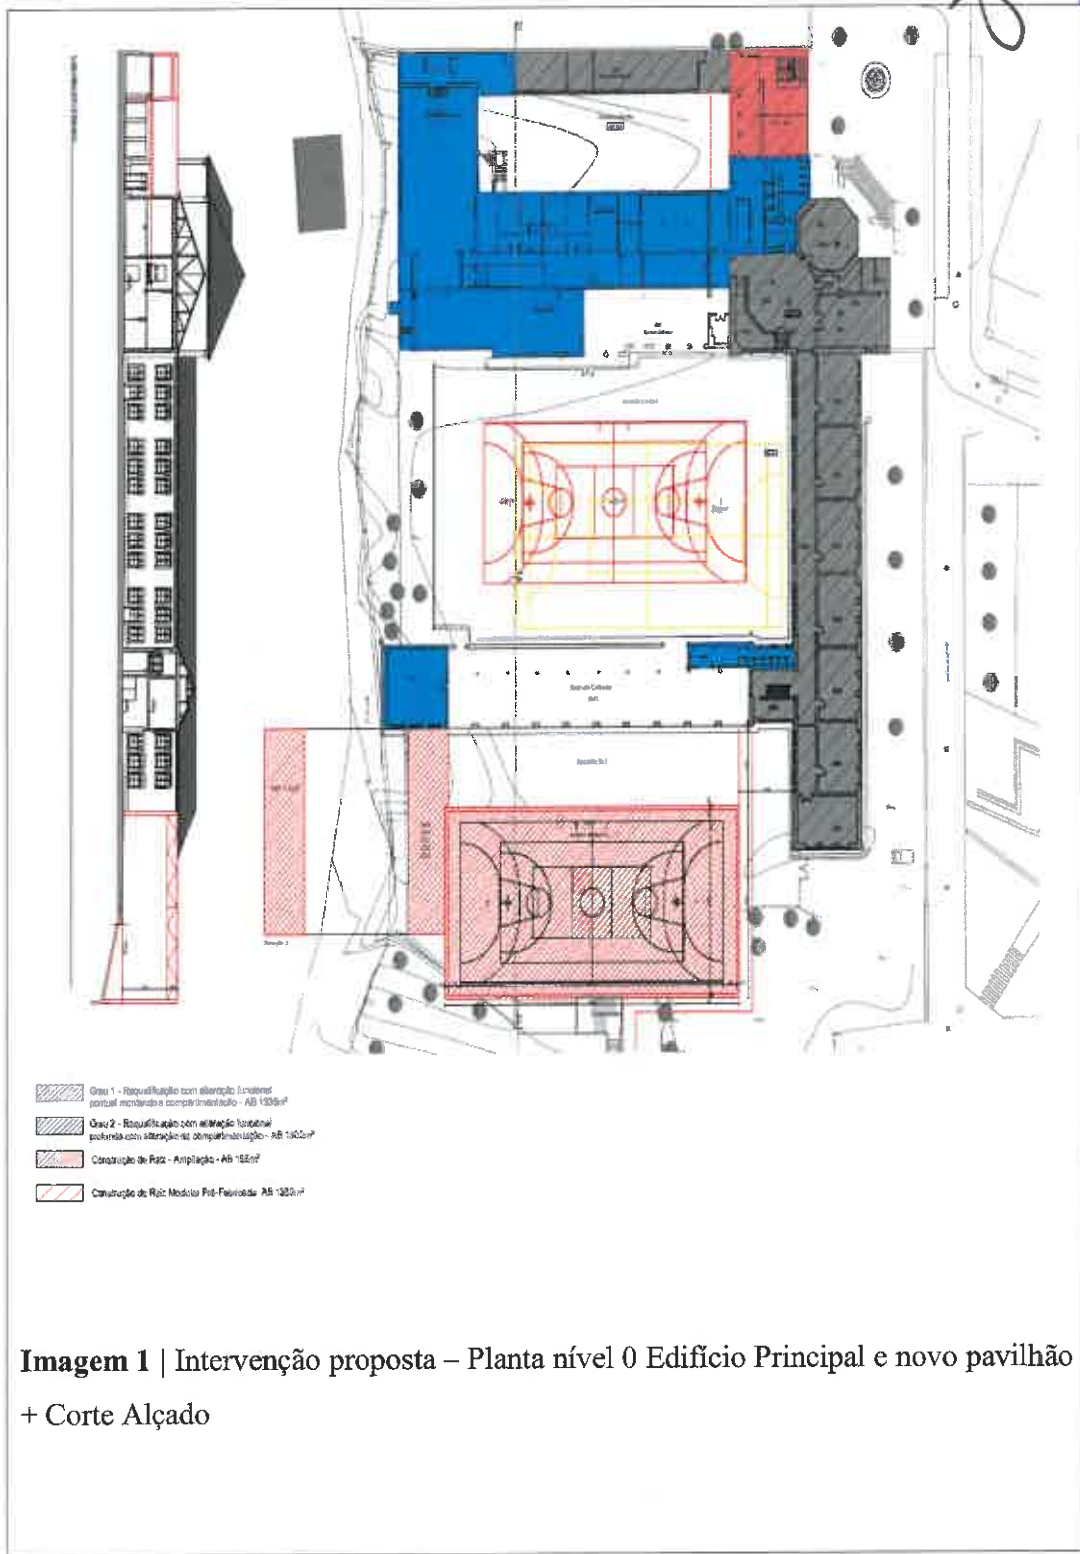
| Intervenção proposta – Planta nível 0 Edifício Principal e novo pavilhão + Corte Alçado
